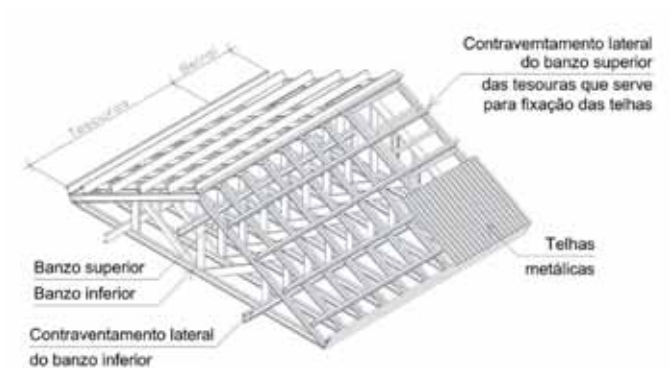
Telhado estruturado com tesouras com cobertura em telhas de aço.
